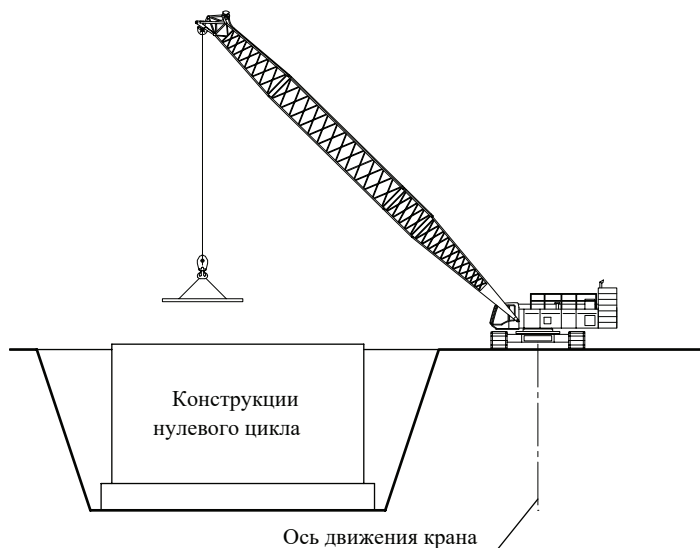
Схема работы крана при возведении подземной части здания (движение крана предусмотрено по бровке котлована с одной стороны здания)
